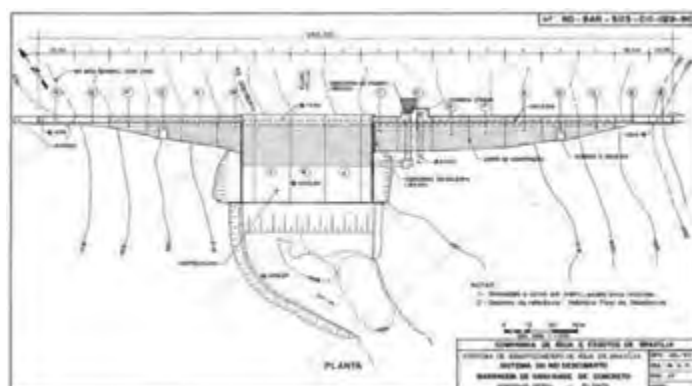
Barragem Rio Descoberto - Arranjo Geral – Planta
